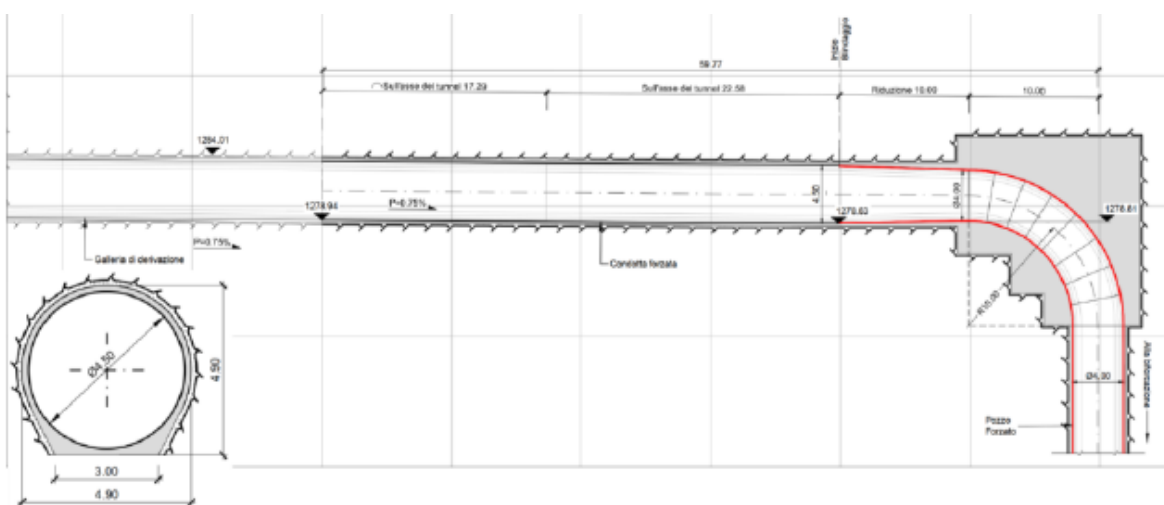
Nuova condotta forzata – profilo e sezione tipo
